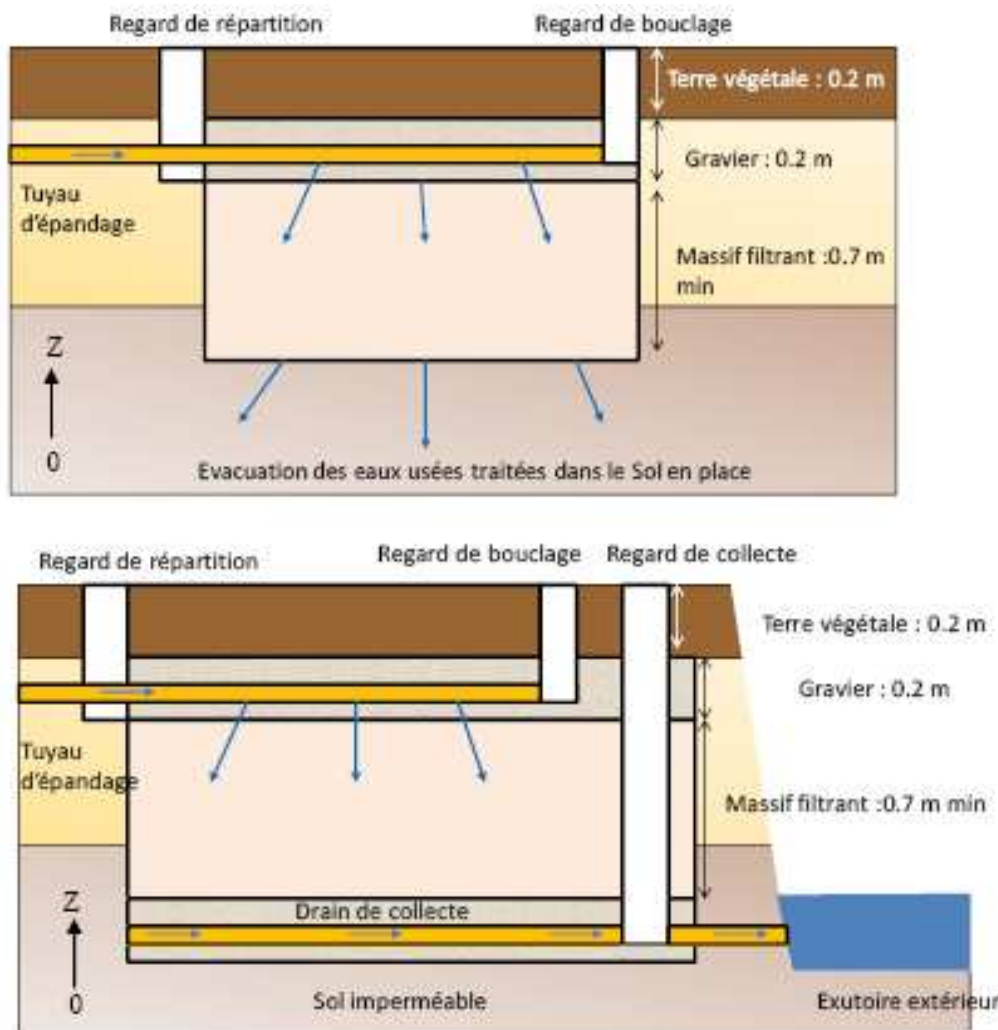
Coupe longitudinale du filtre à sable non drainé (en haut) et drainé (en bas).
